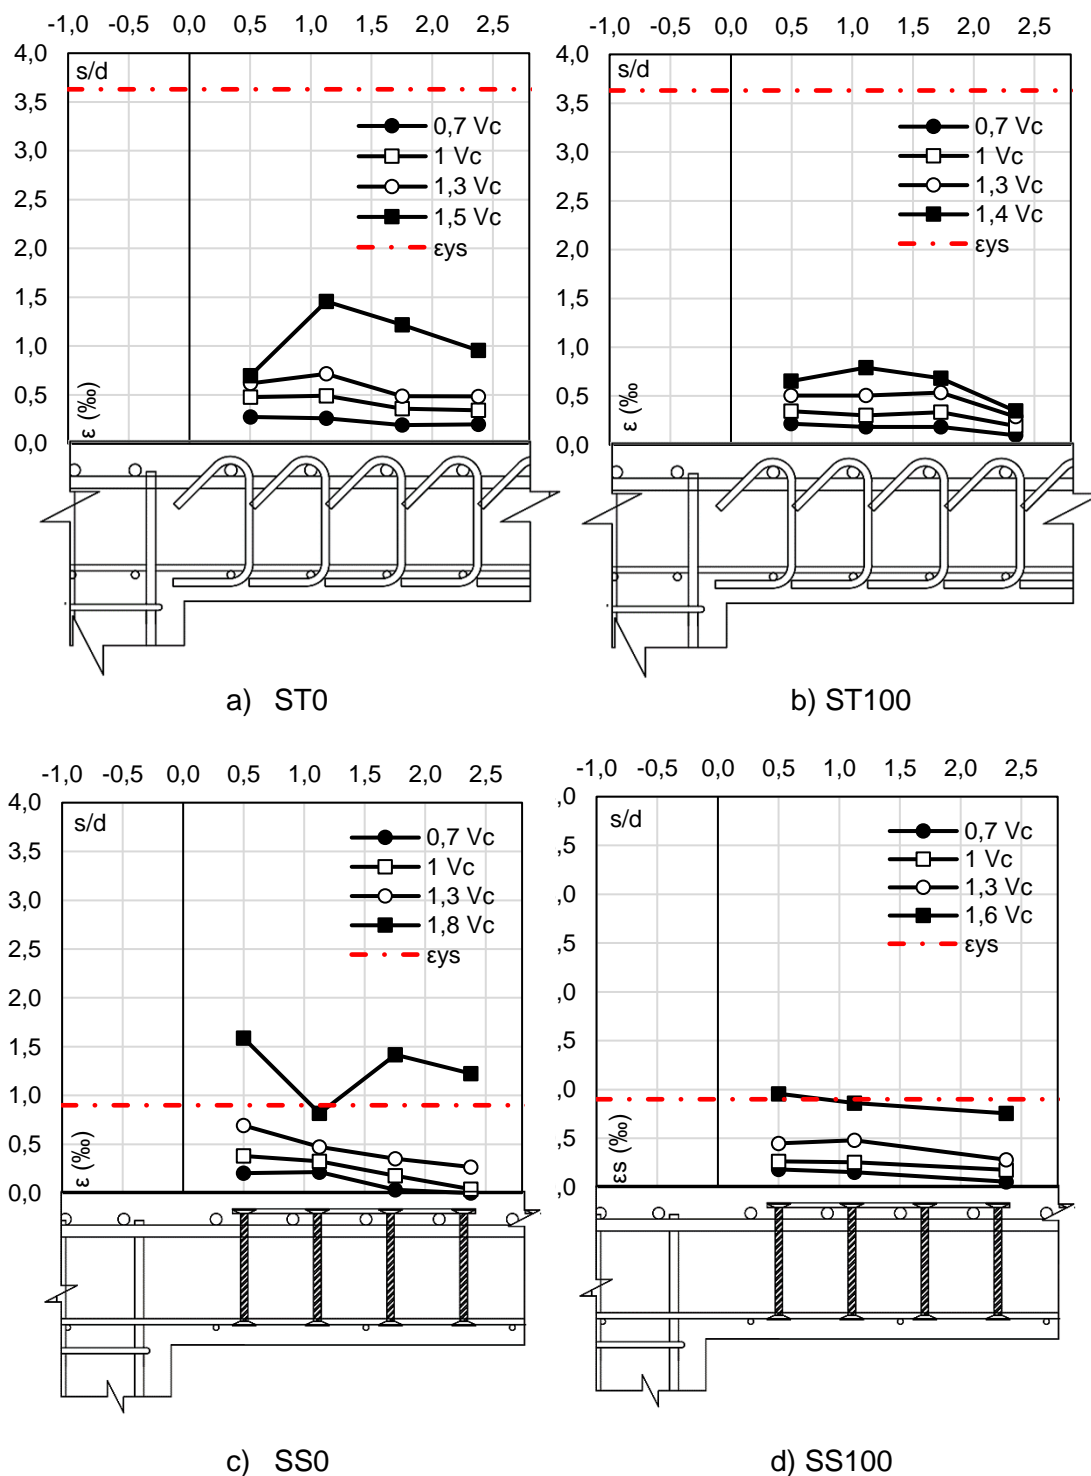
Perfil de deformações de cisalhamento das lajes testadas (Autora, 2023).
